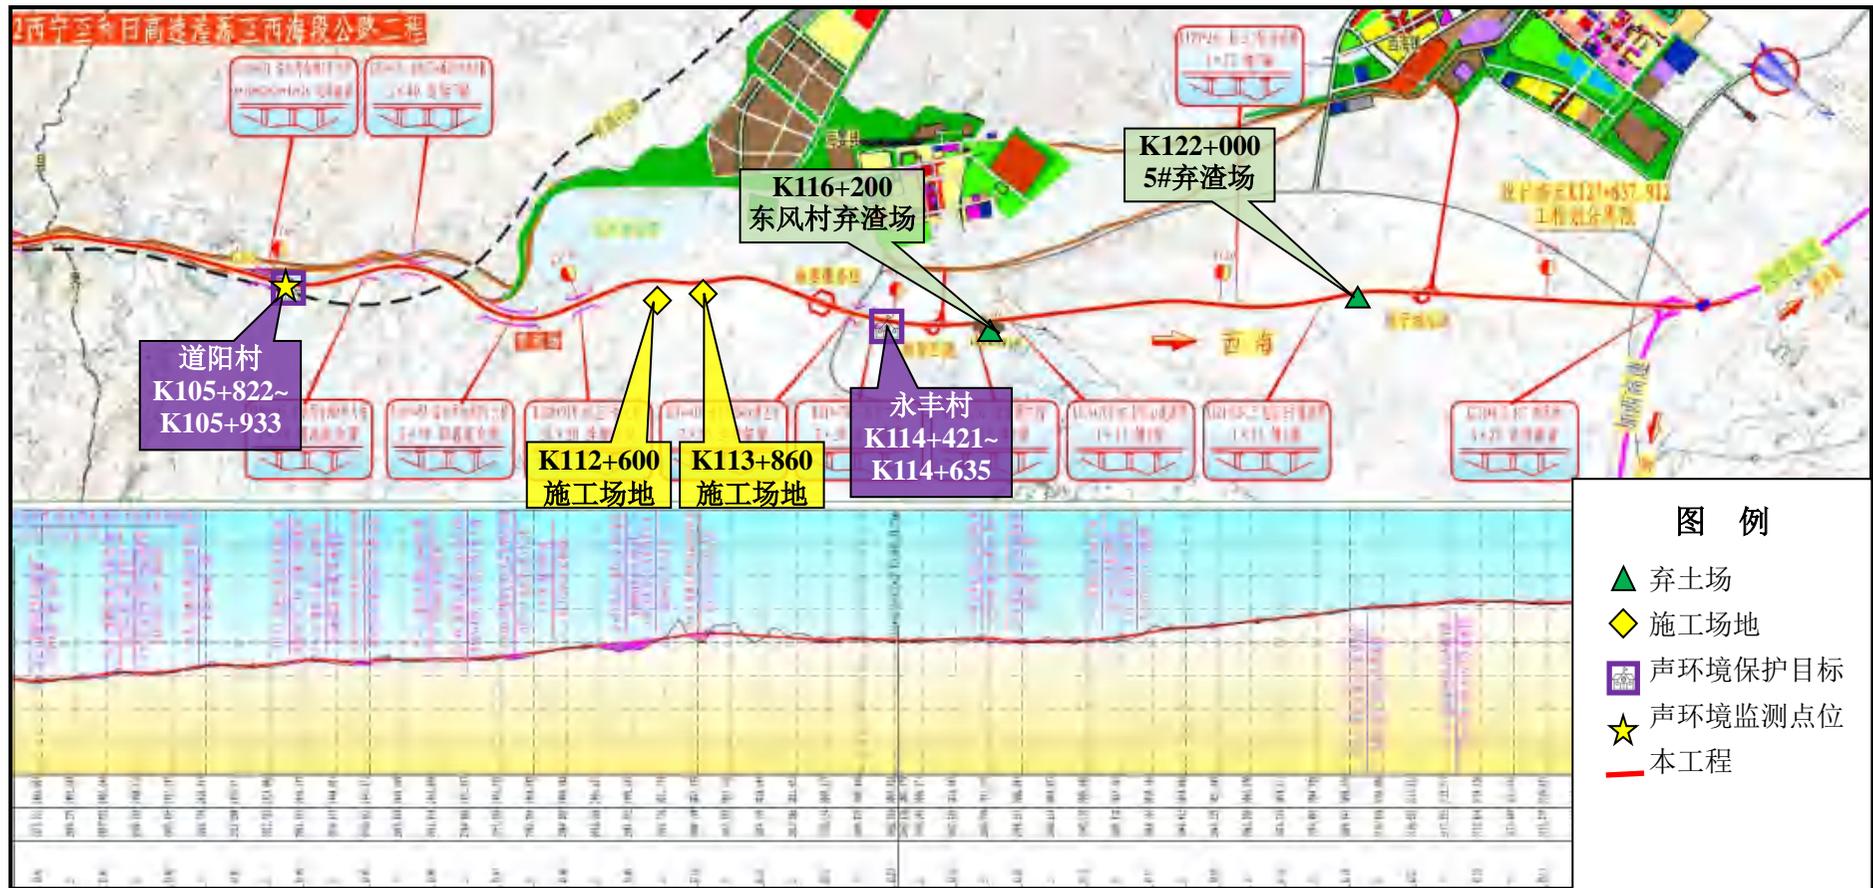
本工程路线走向及线位总体平面布置示意图（2）
